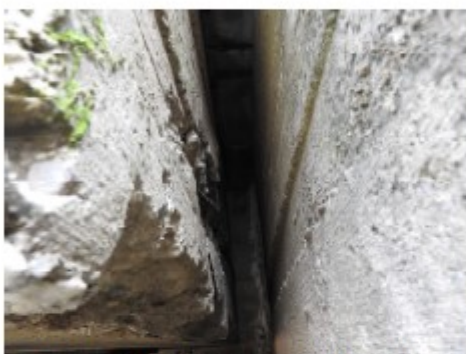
K 01 Pravý nosník, degradovaný beton čela nosníku nad O 02.
